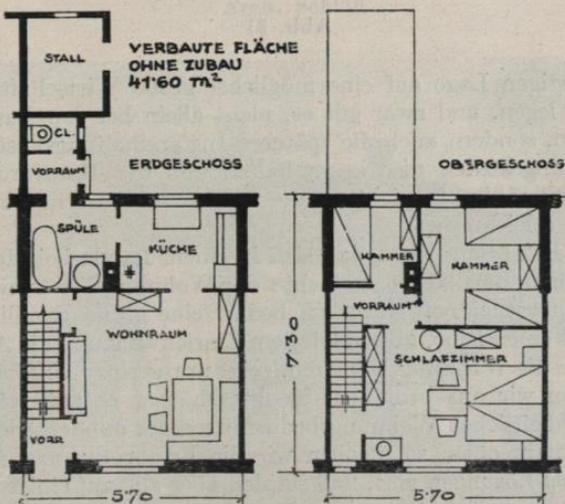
31. Siedlungshaustypengrundrisse aus verschiedenen Ländern
